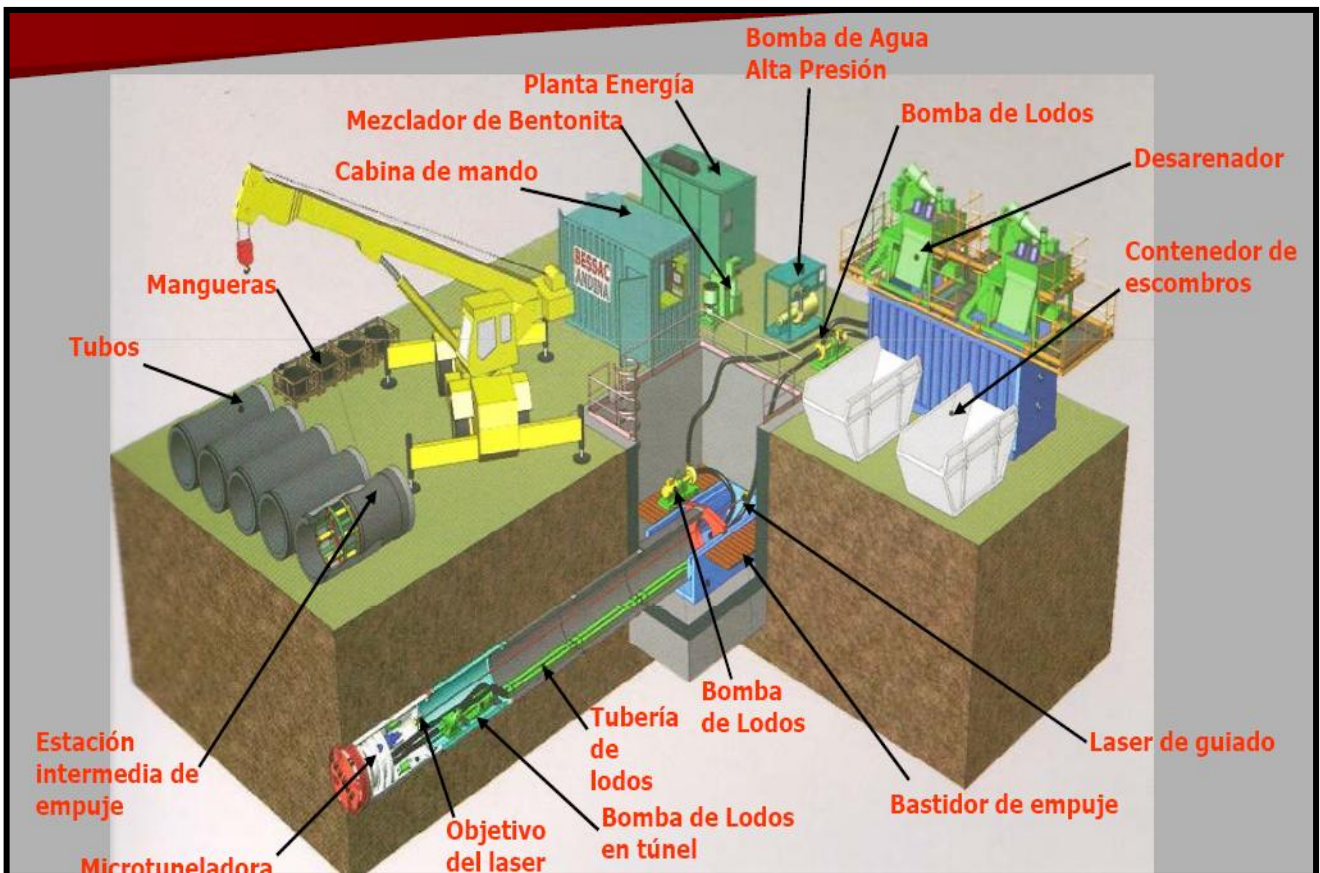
Vista general de una obra con tecnología Pipe Jacking AVN. Bessac 2011
